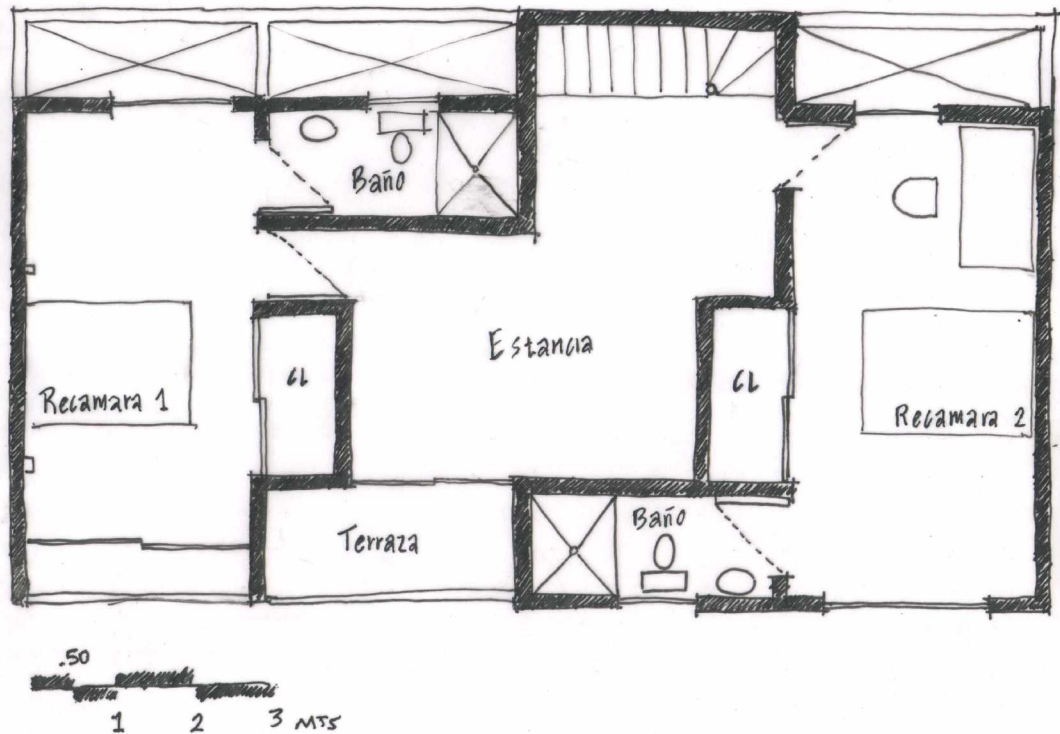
BOCETO DE VIVIENDA 4 ESPACIOS PLANTA ALTA
